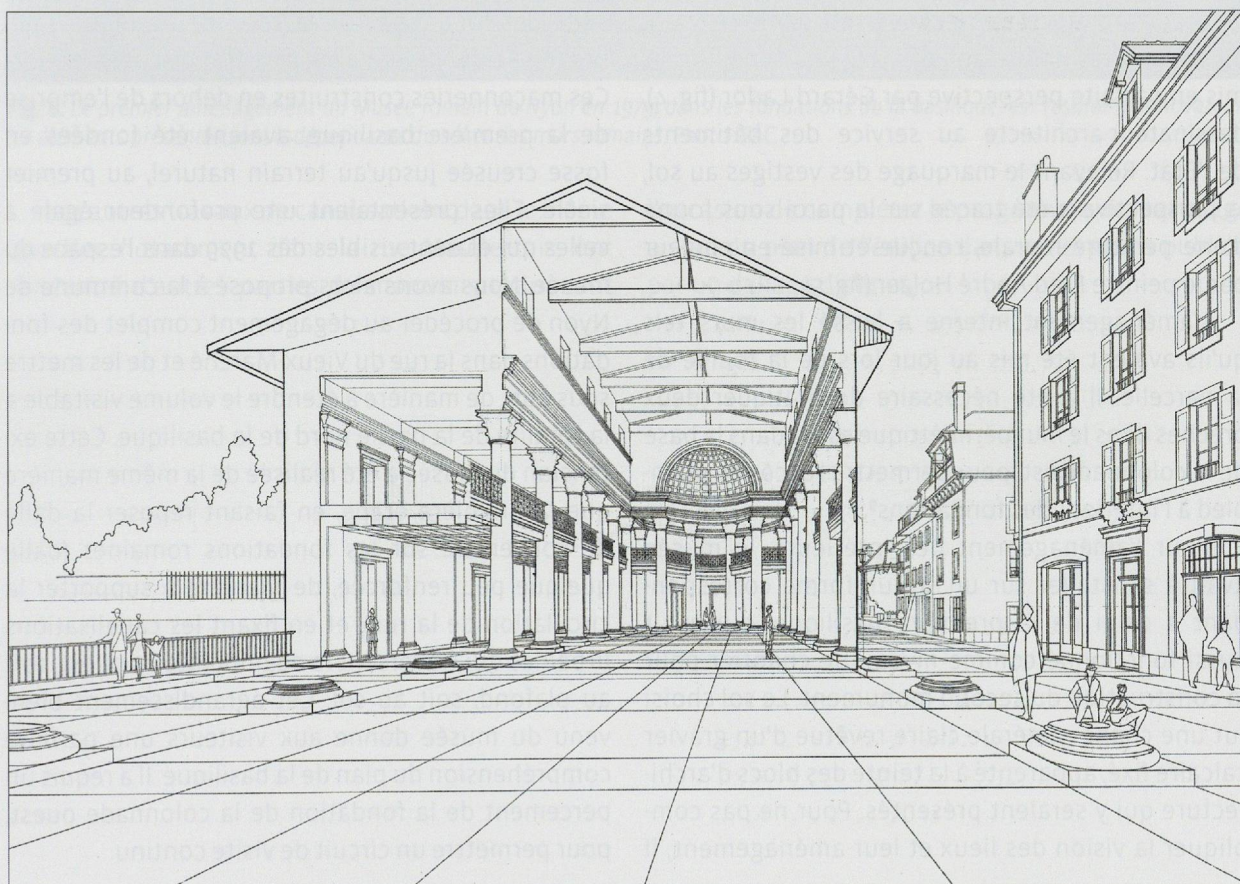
La mise en place du dessin de la basilique à l'échelle 1:1, sur la façade de l'immeuble voisin, est basée sur une perspective rigoureusement construite, de manière à prolonger parfaitement le tracé du plan du monument, sur la place publique au dessus du musée. Le module de la colonnade a été défini à partir d'un chapiteau découvert dans la rue du Vieux-Marché attribué à la basilique. Construction et dessin de G. Lador, 1978.
